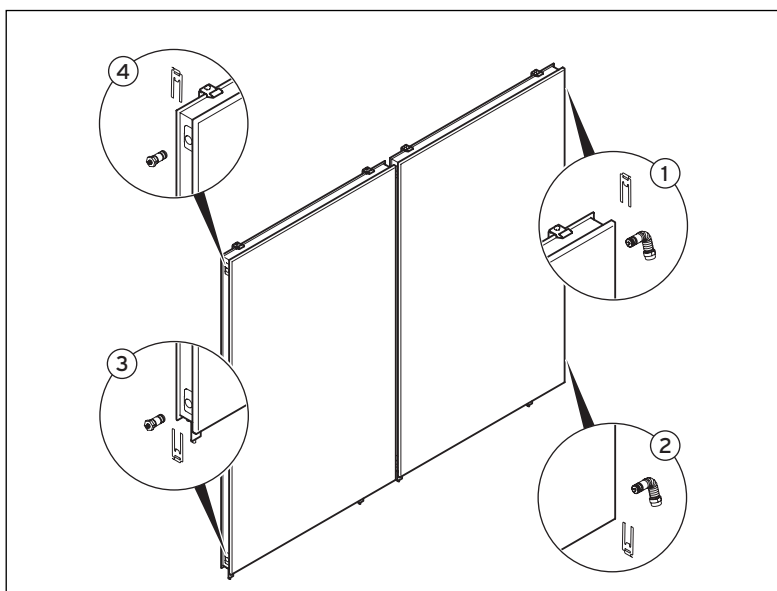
Montáž hydraulického připojení na obou stranách
